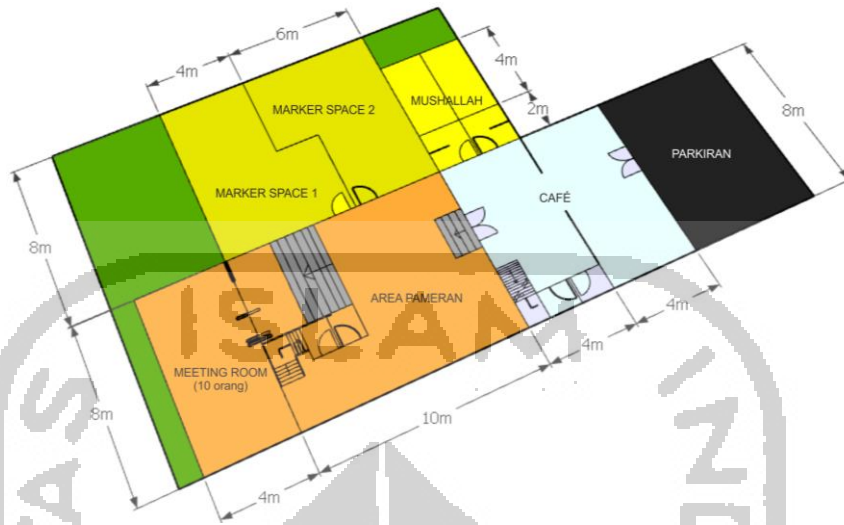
21 alternatif fleksibilitas ruang pameran 1
